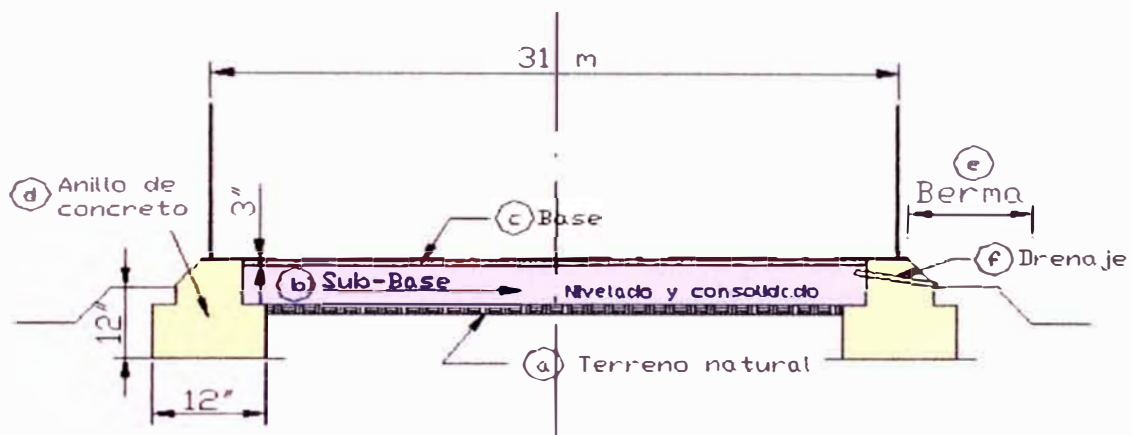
CIMENTACION DE TANQUE TIPO ANILLO DE CONCRETO REFORZADO
